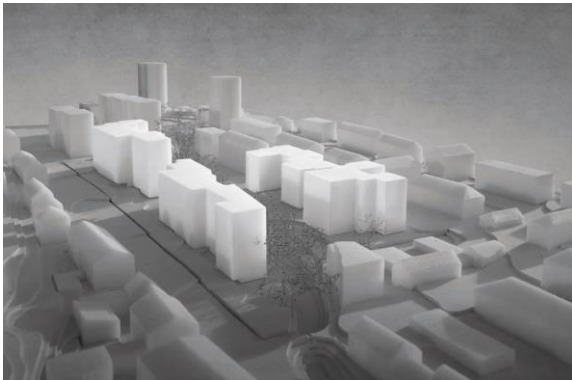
Variante "Gefasster Raum": Situationsplan und Modellfotos
